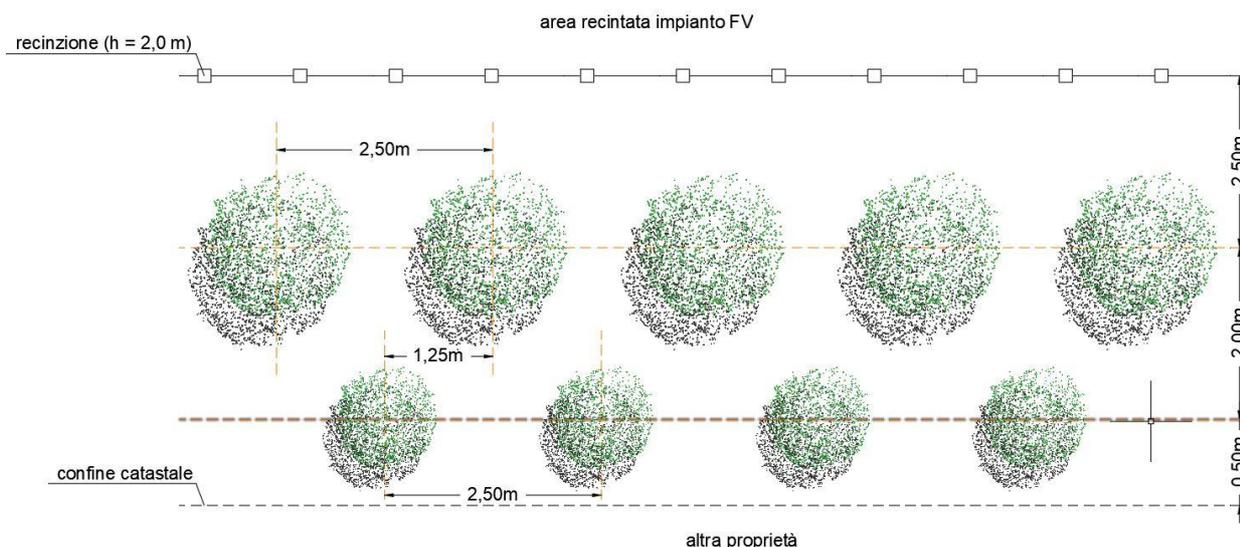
Siepe polispecifica (planimetria di progetto).
